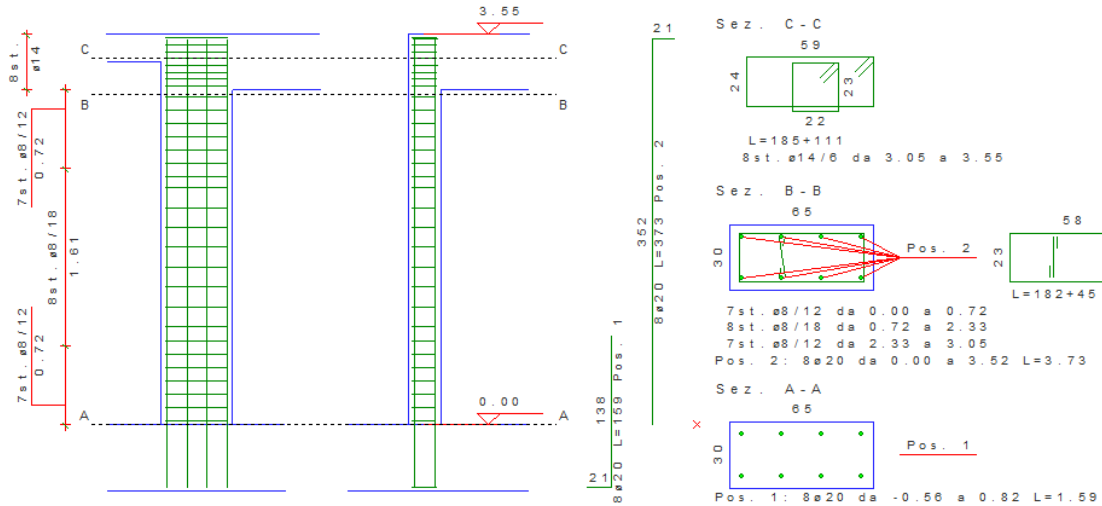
PILASTRO N. 1, 6, 7, 12
